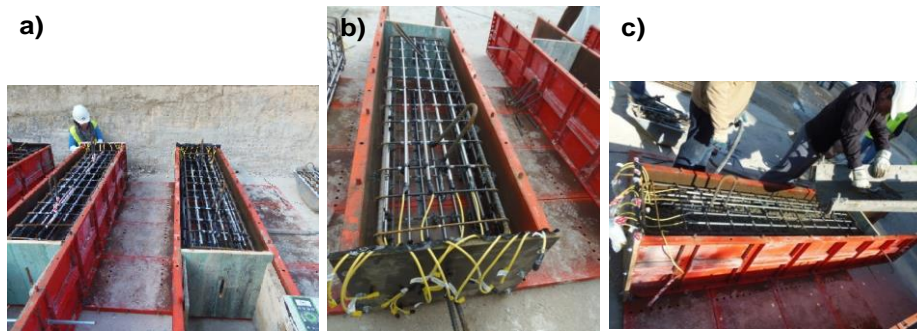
a) y b) Colocación de barras y cableado exterior antes de hormigonar. c) Hormigonado.
